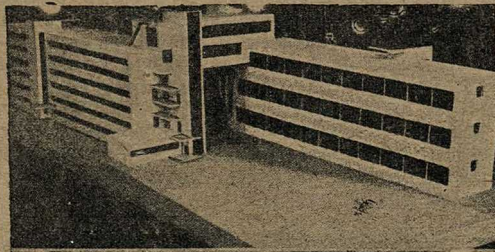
Проект рабочего жилого дома, в котором окна опоясывают все здание в несколько этажей. Простенки убраны, и свет льется в комнаты широким потоком во всю ширину стены каждой из них.
